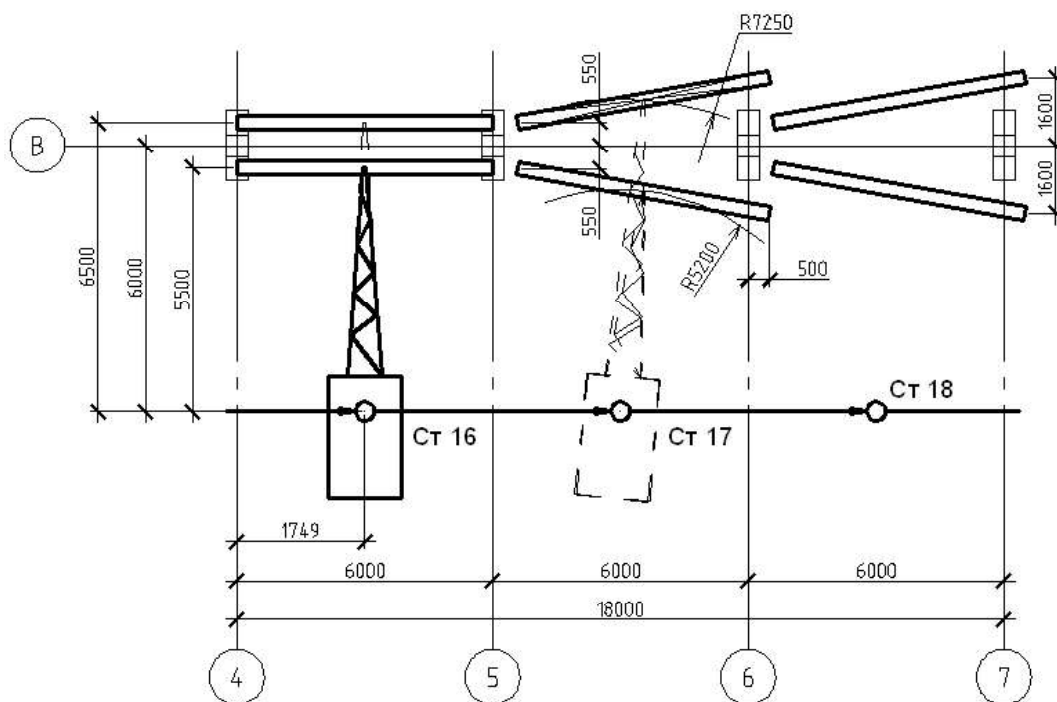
Схема монтажа подкрановых балок длиной 6 м по колоннам среднего ряда.
